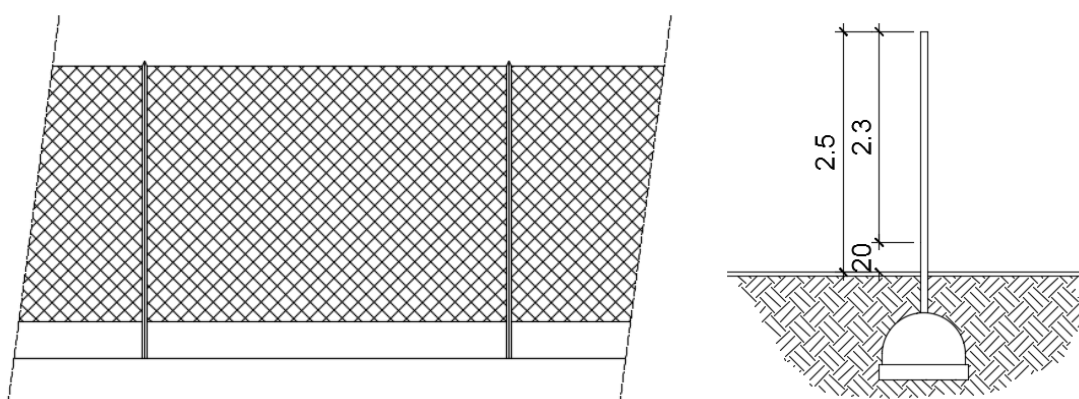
Cerramiento perimetral de la depuradora. Vista en alzado y perfil.
